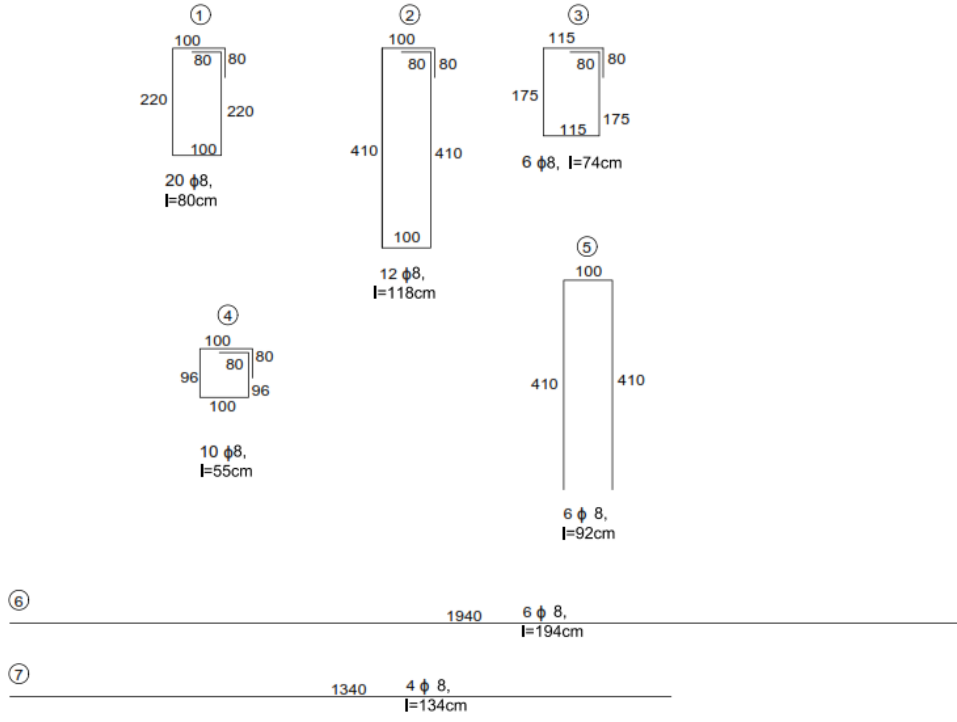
Deney Elemanı - 1 donatı detayı planı
